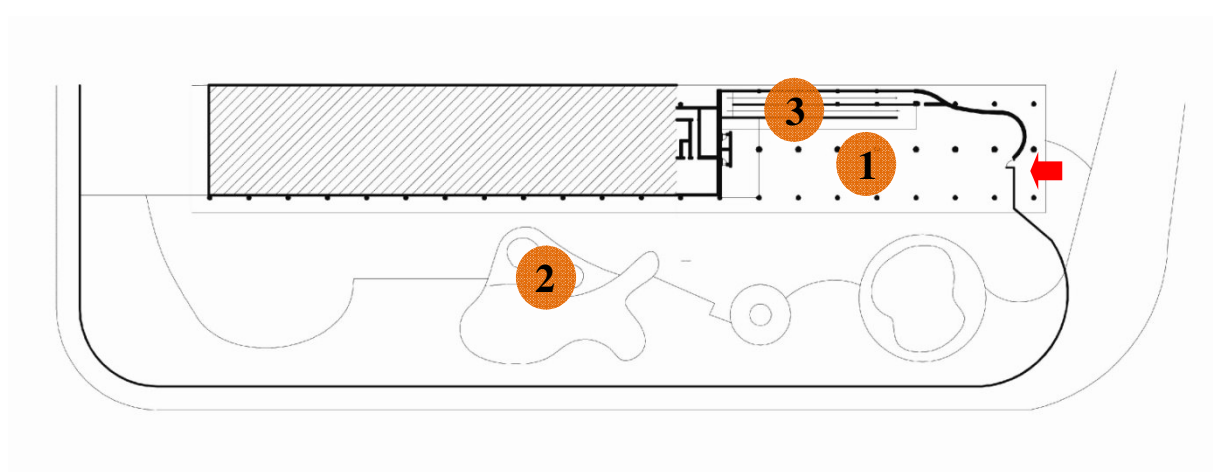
planta baixa primeiro pavimento, referenciando os espaços indicados no quadro de áreas.
